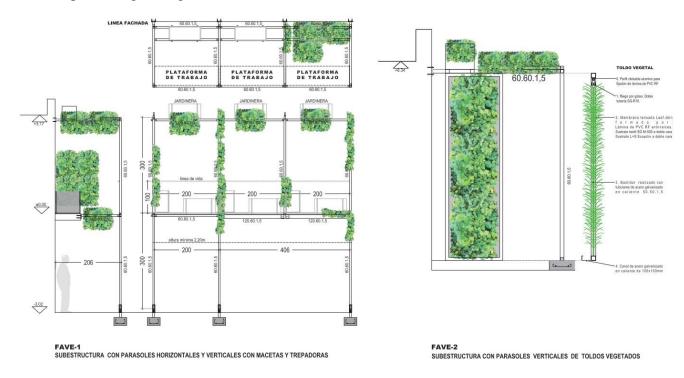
Detalle constructivo del mBiGFAVE. Fuente: Proyecto básico y de ejecución CEIP Gabriela Mistral
